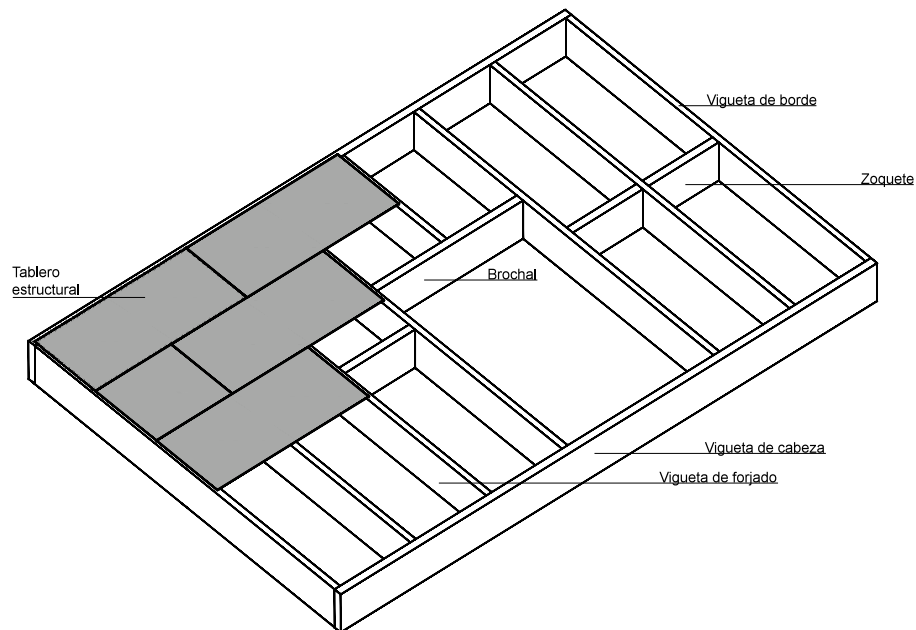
Estructura del entramado horizontal de un muro de carga del sistema de plataforma. Ver texto para detalles de los componentes.
